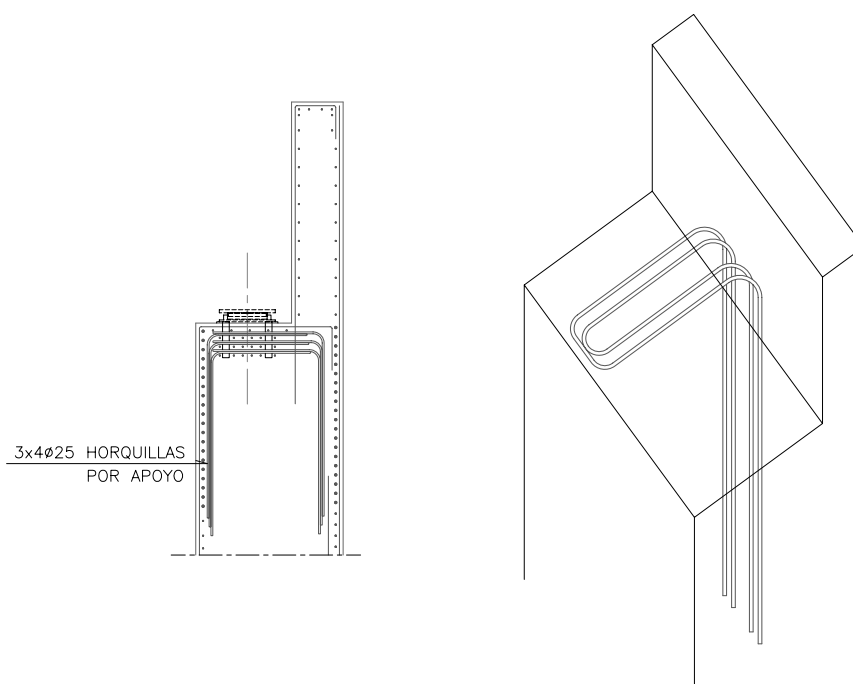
Armadura de transmisión local de la fuerza de un apoyo fijo
